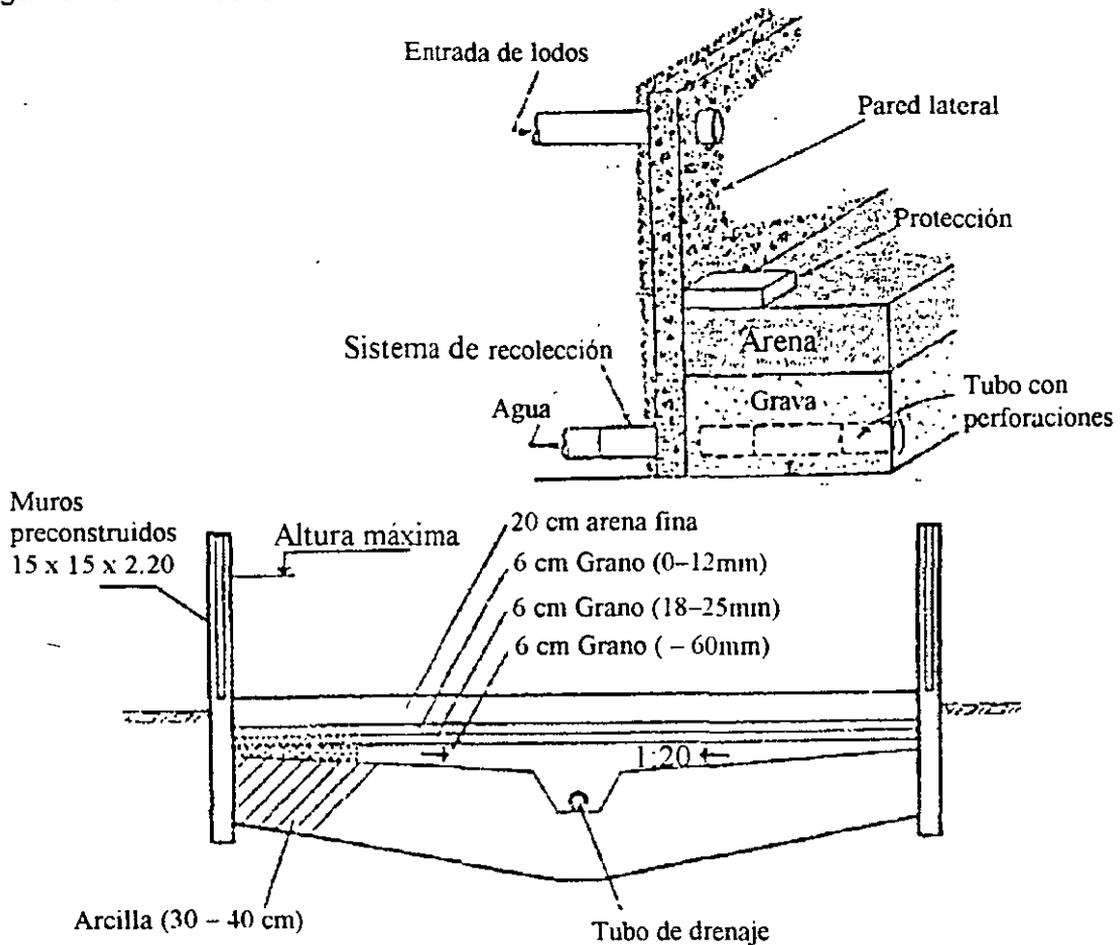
Corte constructivo y granulometría de los lechos de arena
